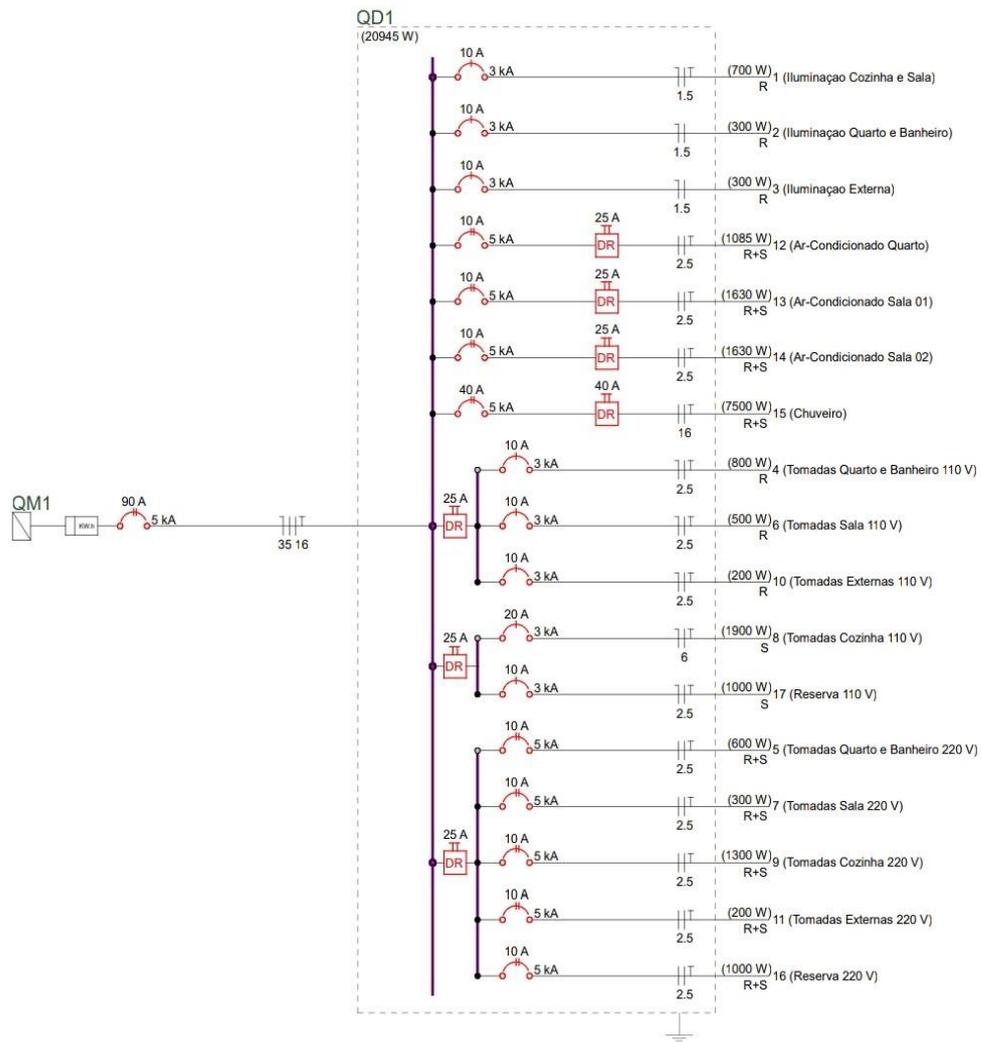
Foto do Projeto II: Foto tirada pelo autor.
